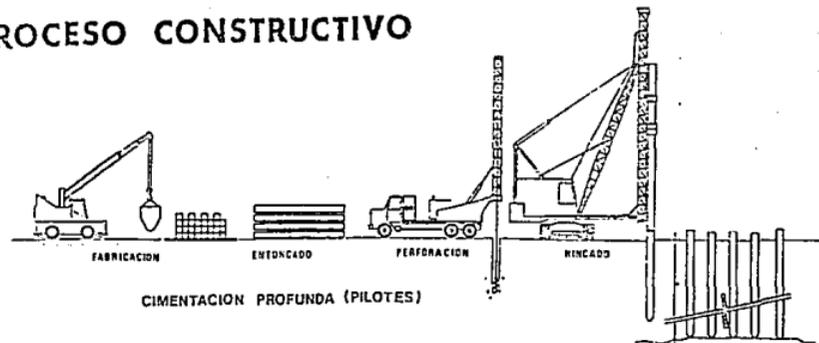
PROCESO DE FABRICACION E HINCADO DE PILOTES
